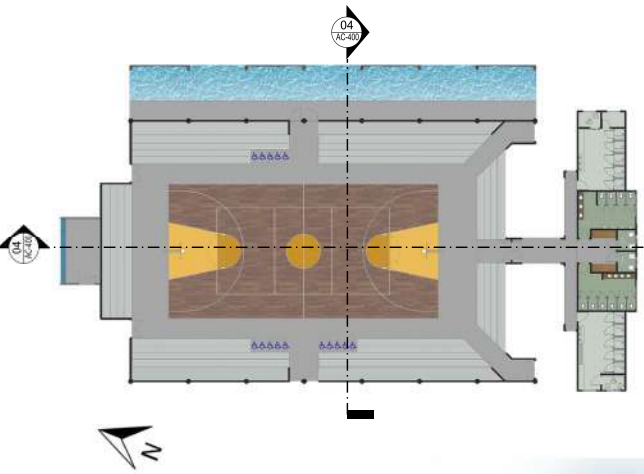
Planta arquitectónica Gimnasio Multiuso. Fuente: Propia.
